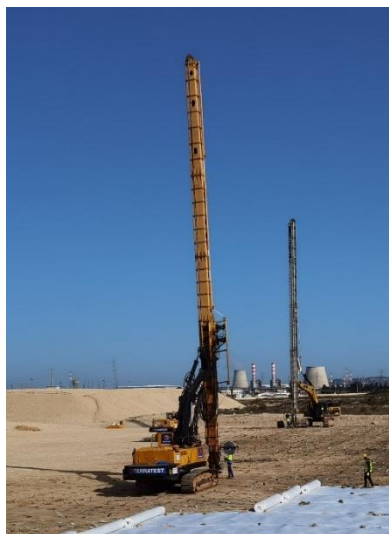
Execução de drenos verticais pré-fabricados (torre de cravação).
